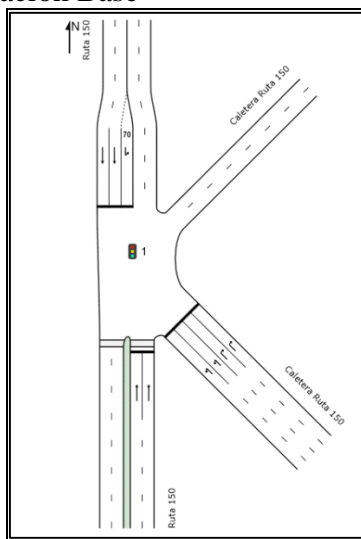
Layout Modelación Situación Base intersección Outlet. Fuente: Sidra Intersection
